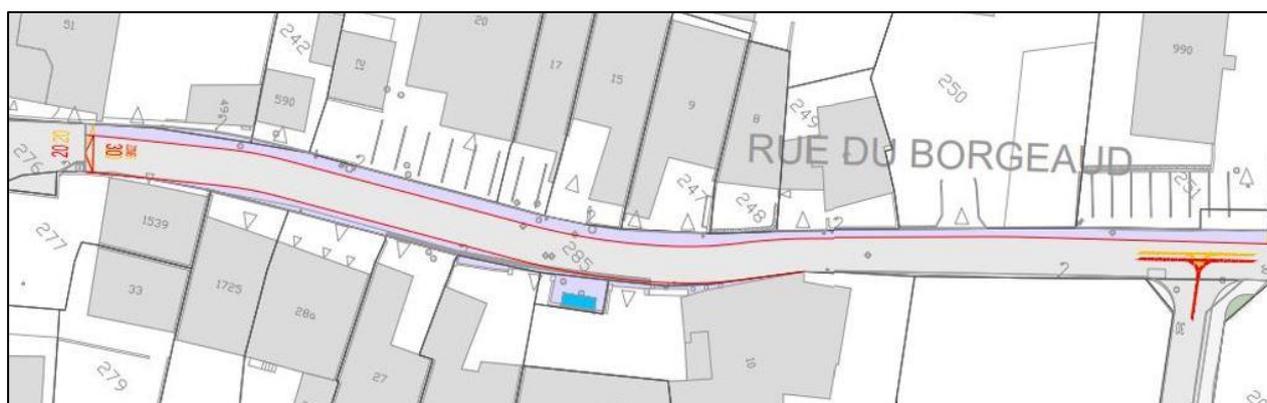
plan d'enquête 2020 (en jaune) et plan modifié (en rouge)
